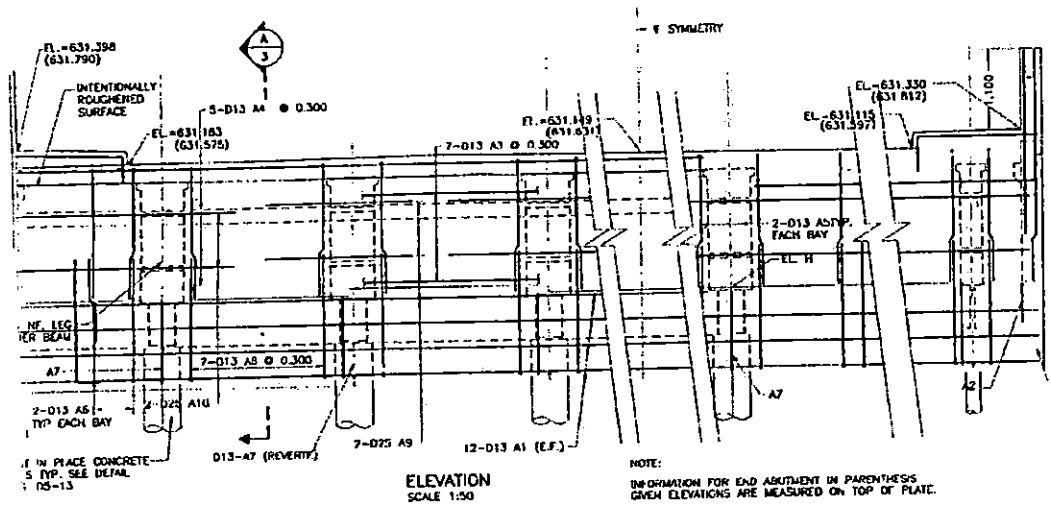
ELEVACION DE ESTRIBOS.
